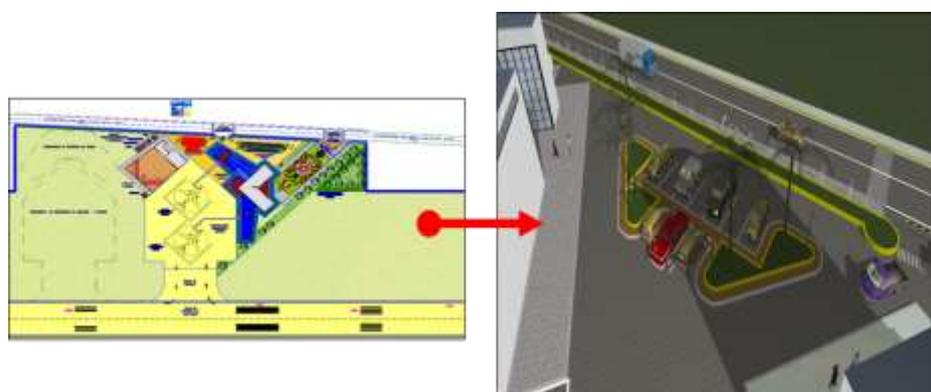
Estacionamiento Privado; Fuente: Vistas 3D.
